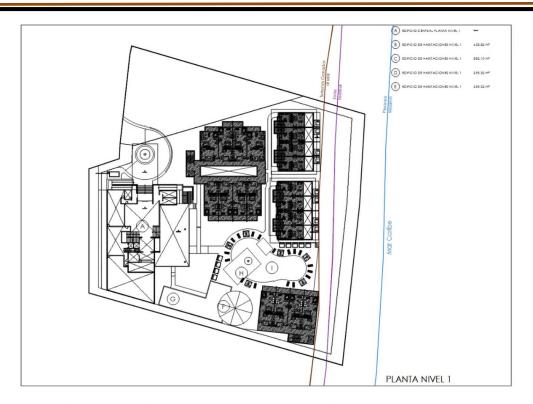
Plano arquitectónico de la planta nivel 1 del proyecto.
